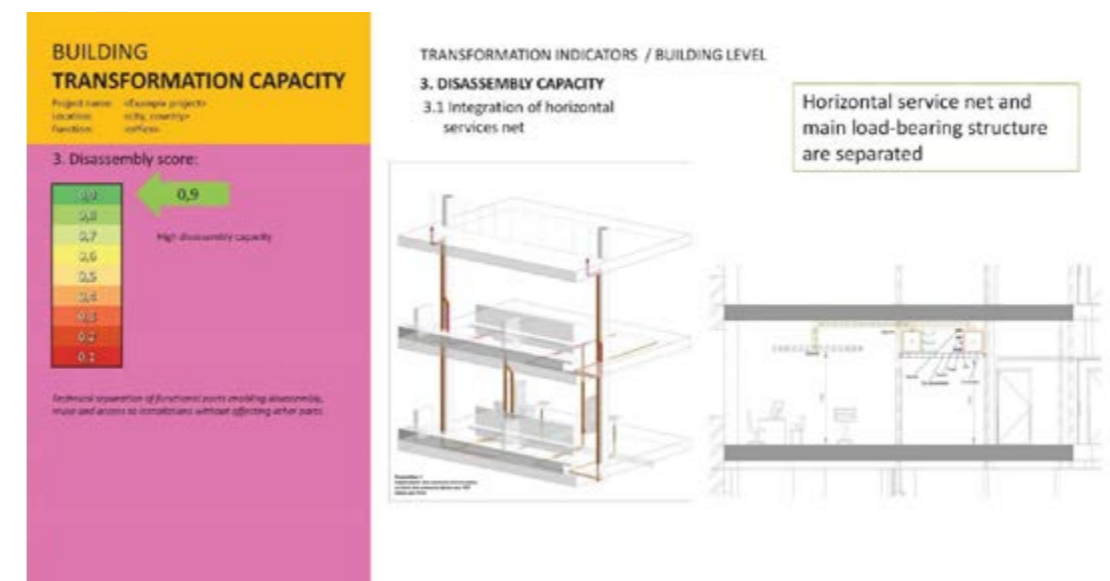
Les conduites et gaines techniques sont séparées de la structure porteuse, ce qui permet de les adapter facilement. L'espace pour la distribution horizontale et verticale est surdimensionné, facilitant les modifications ultérieures. (Source : archipelago architects)
